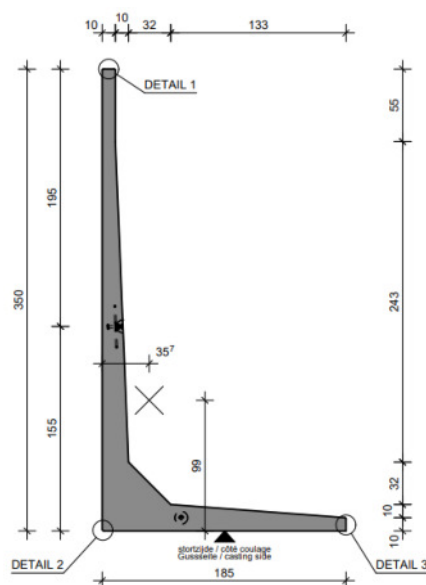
Coupe type d'un mur préfabriqué (Source : site internet CBS béton)
